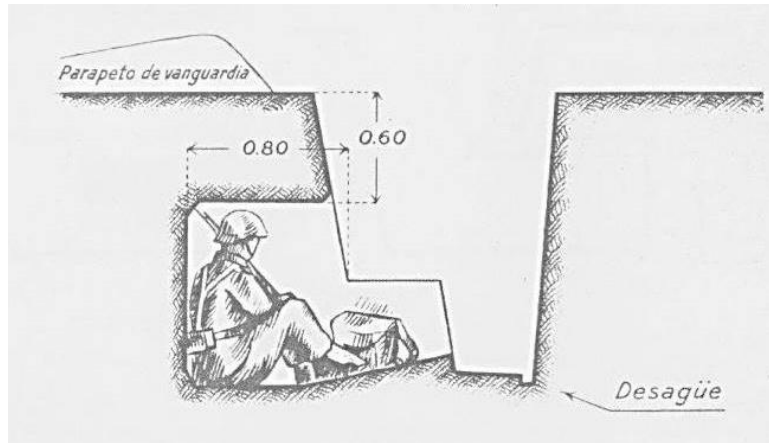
Abrigo debajo del parapeto (Capdevila, 1938).
